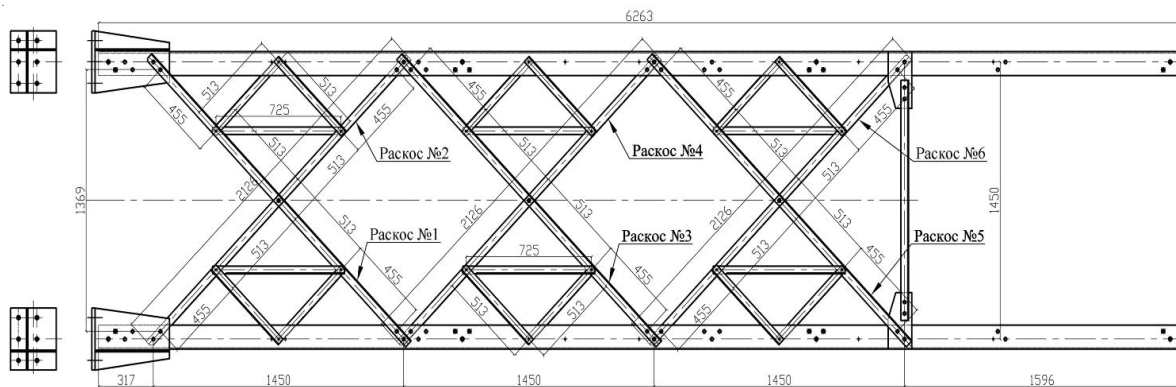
Монтажная схема испытуемой плоской фермы (раскосы из уголков  $L45 \times 4$ ).
